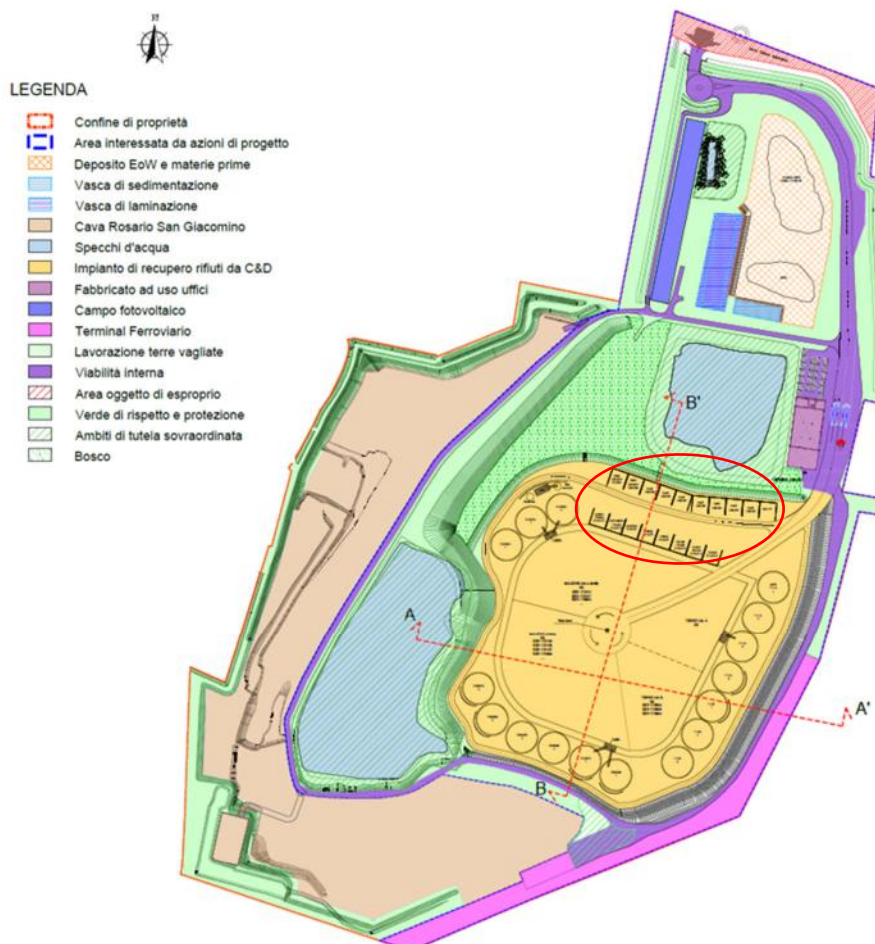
Individuazione zona box prefabbricati/misto cementato (stralcio Tav. PF T11)
